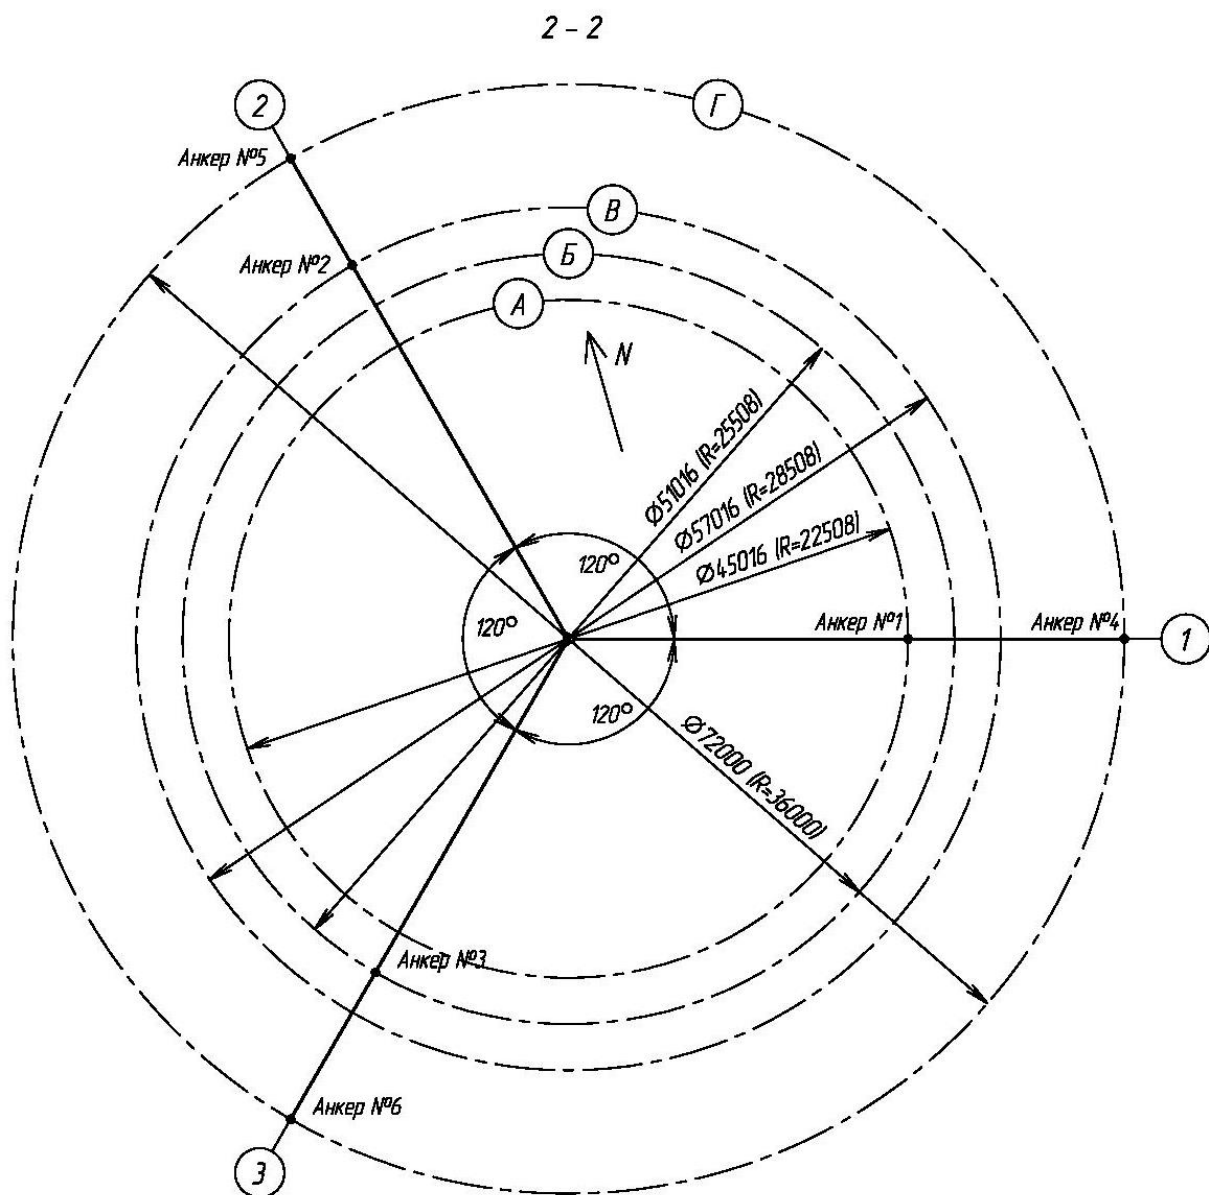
План наращенной мачты с использованием новых анкерных фундаментов для закрепления нижних концов оттяжек двух верхних ярусов
